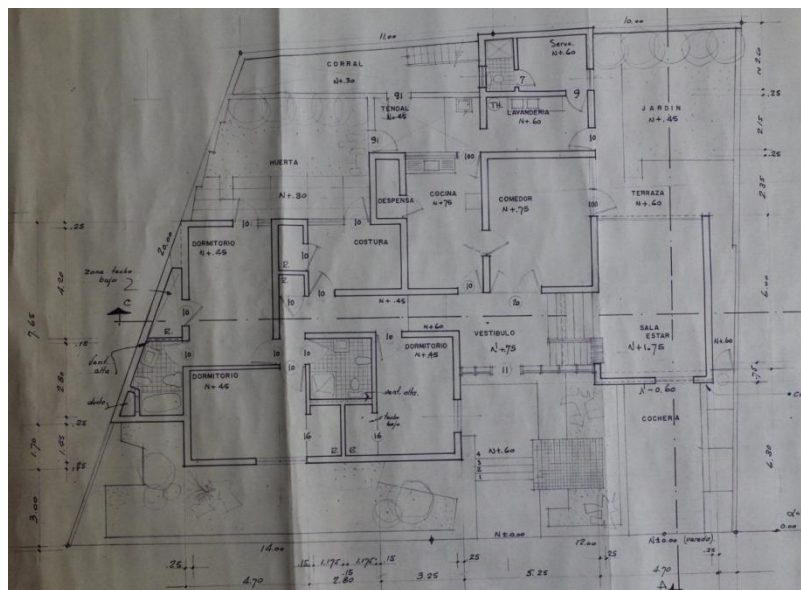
Planta primer nivel. Fuente: Propia.
